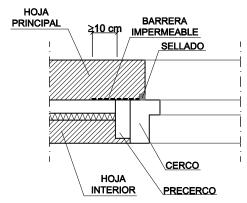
Ejemplo de encuentro de la fachada con la carpintería
